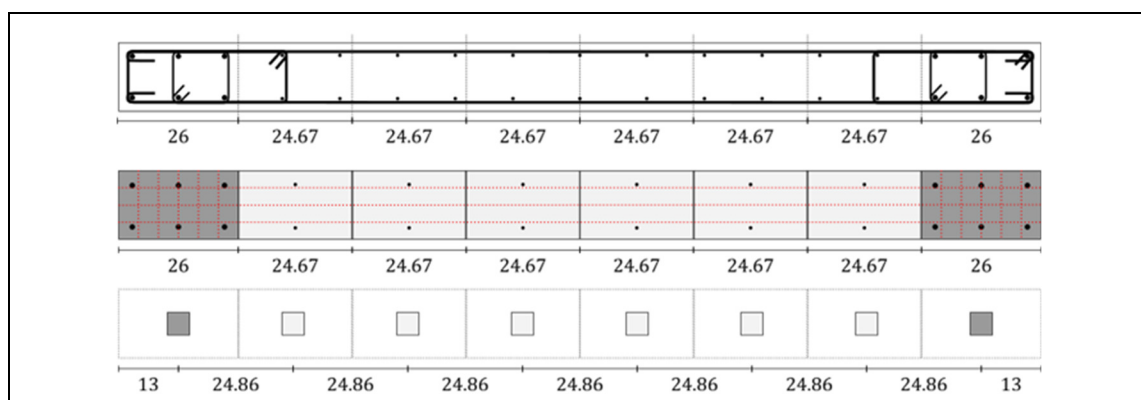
Sección transversal y discretización considerada del muro WSH6, dimensiones en cm.
